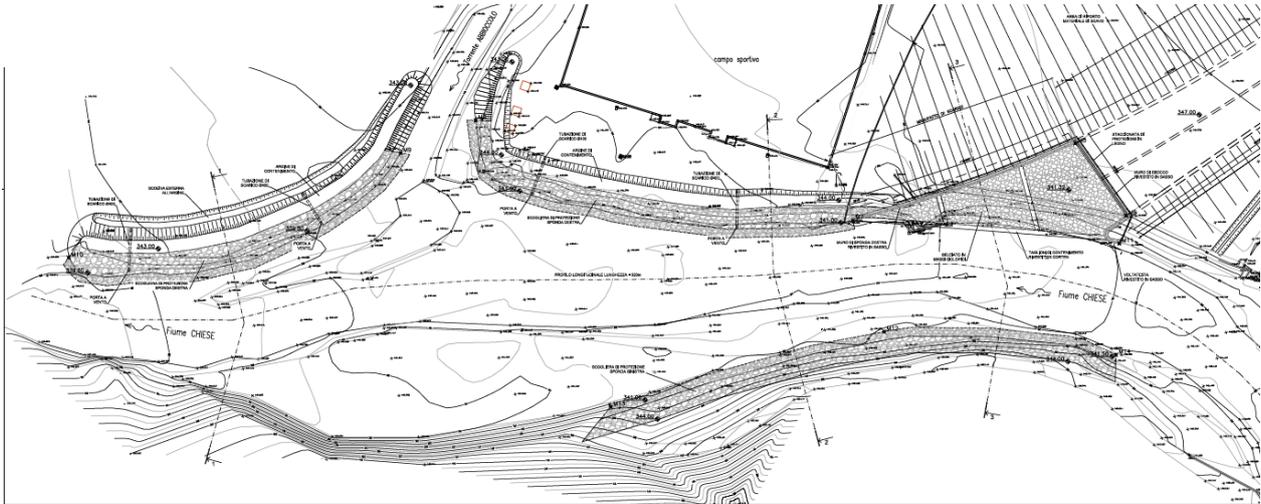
Planimetria opere di restituzione e di protezione confluenza galleria di by-pass / Chiese nel PD (elaborato: D\_DP\_ST\_CAR\_T\_010\_0)
